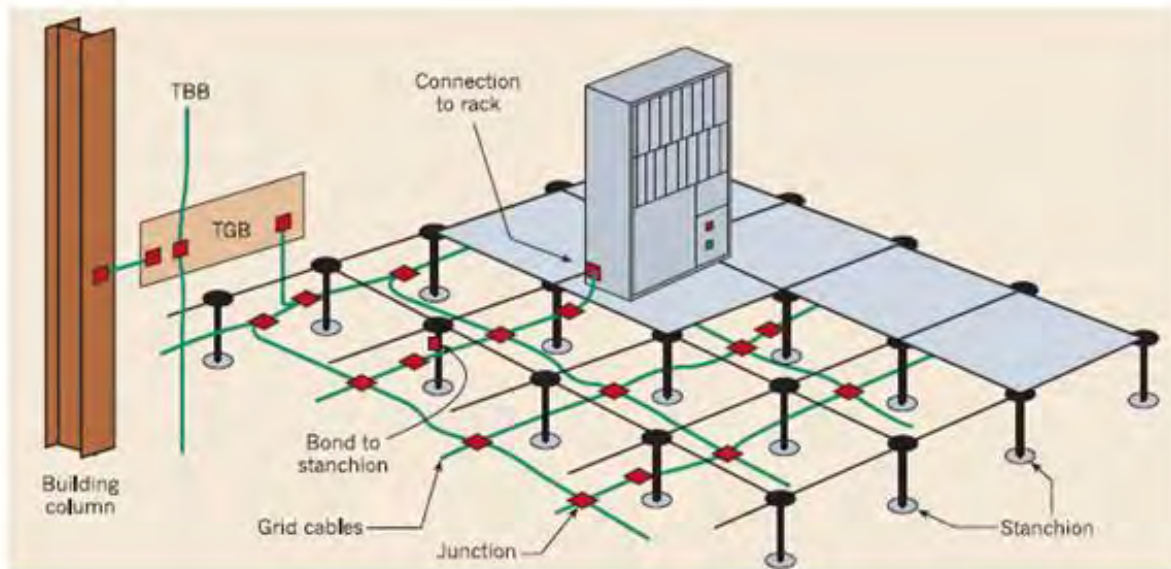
Sistema de puesta a tierra para la instalaciones de cable estructurado, utilizando una red mallada bajo suelo.
